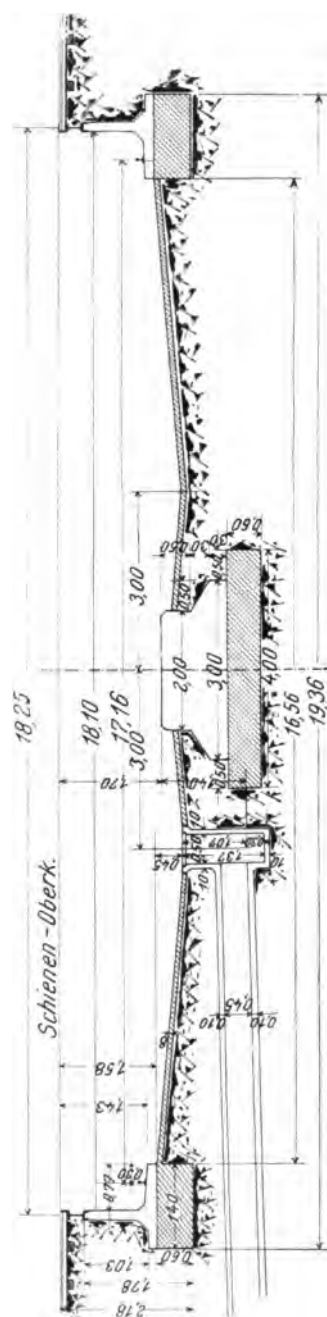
Eisenbeton-Unterbau einer Drehscheibe auf Bahnhof Czegléd.
